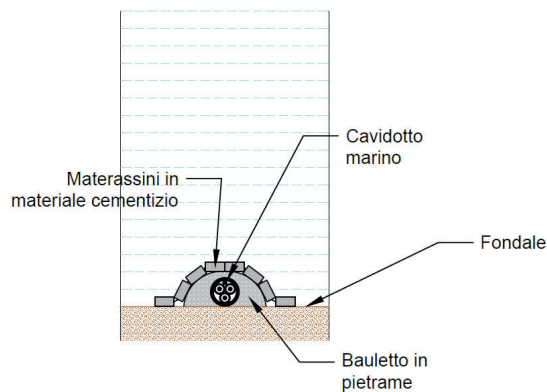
Sezione tipica di posa della linea in cavo su fondale marino.
